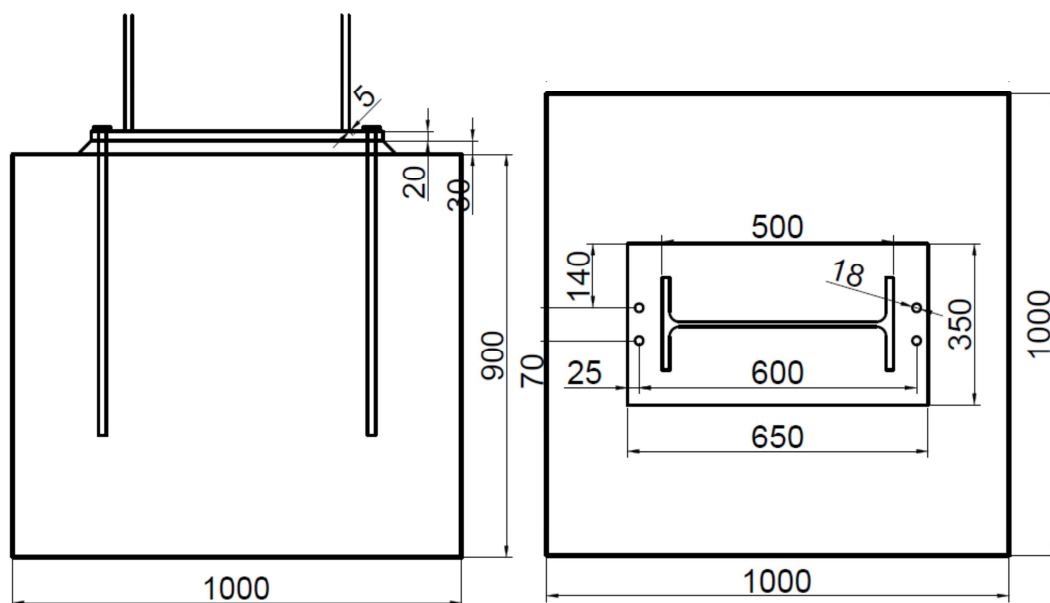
Definição geométrica da ligação do pilar 1 do pórtico 2
